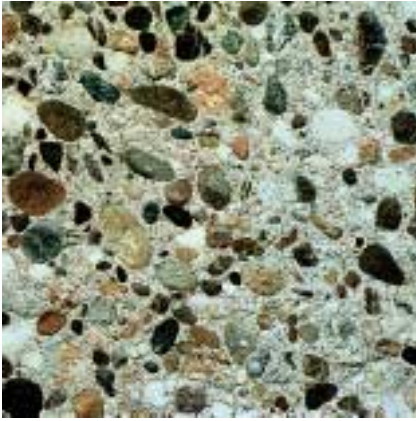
Flammgestrahlte Betonoberfläche, Rheinkies 0-16 mm, weißer Zement, 3 % Titanoxid
